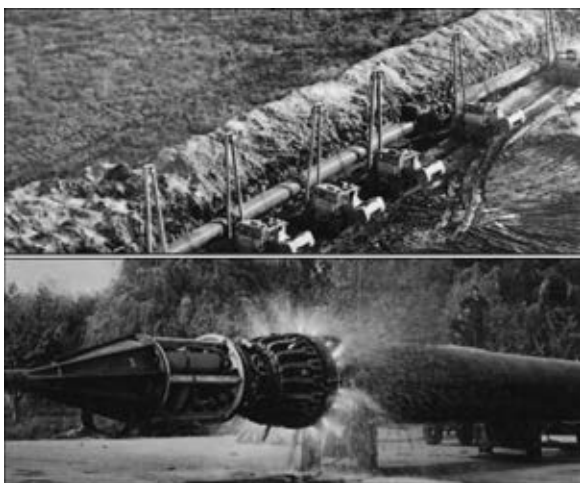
Комплекс «Север» для сварки труб магистральных нефте- и газопроводов
